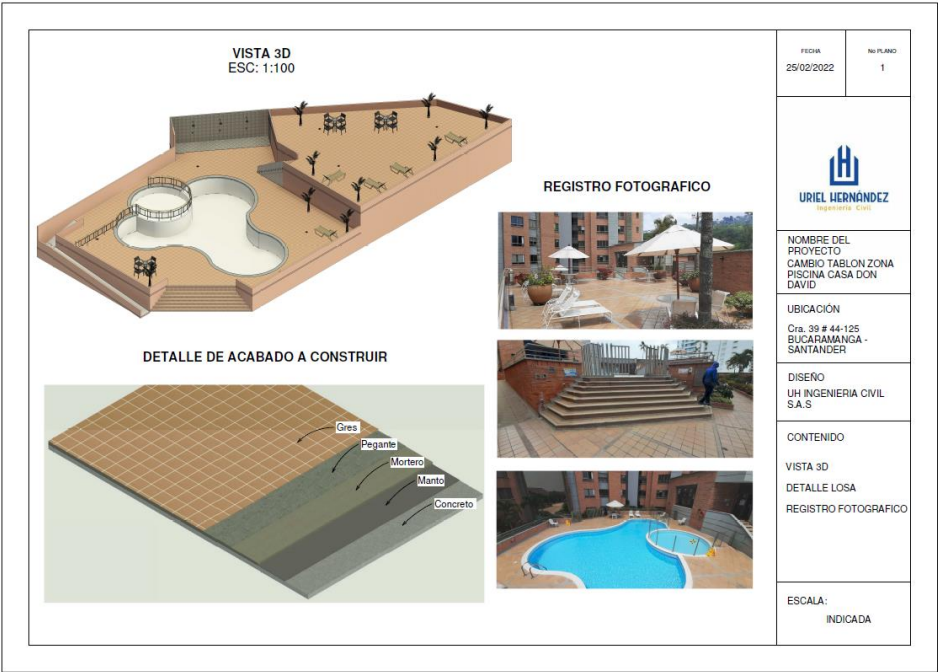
Plano detalles zona húmeda conjunto Casa de Don David
